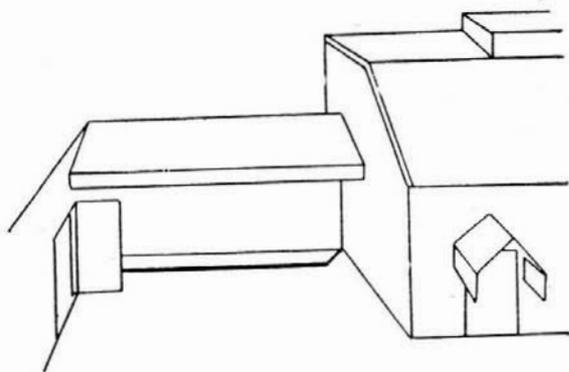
Muricciolo e tettoia, visti dall'interno.
